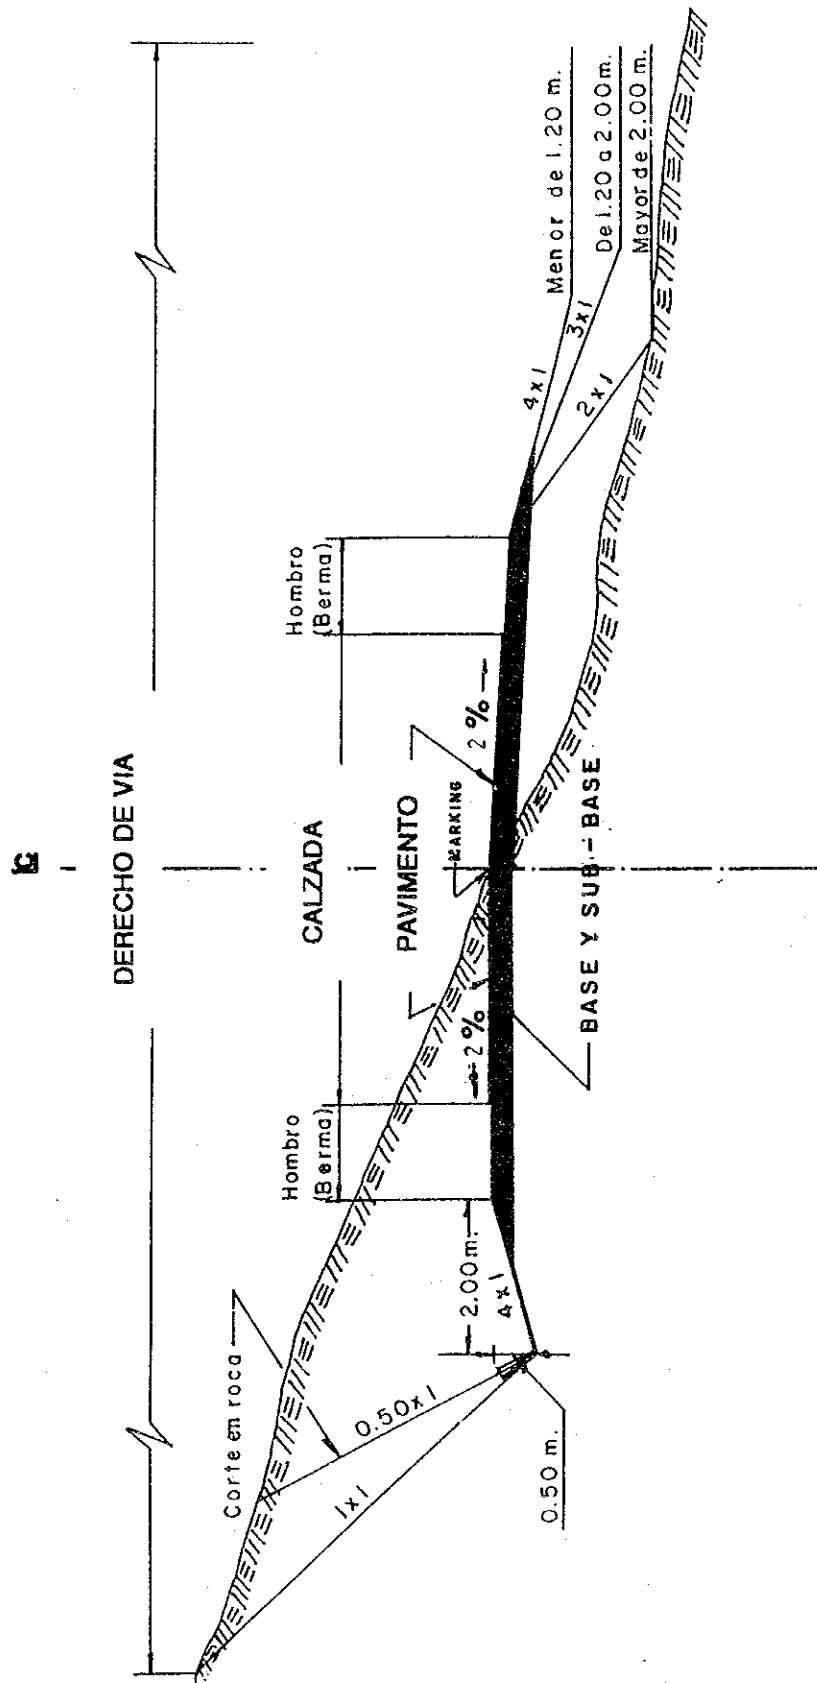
Secciones Transversales Típicas Propuestas (3)
